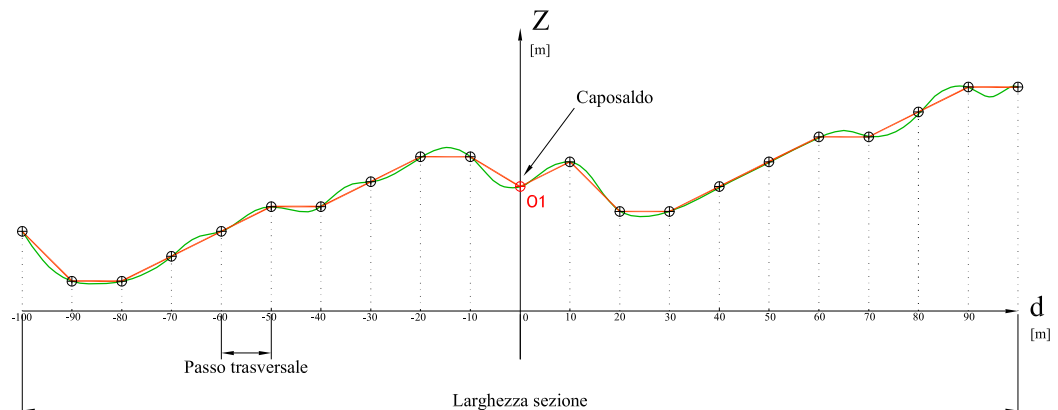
Rappresentazione del terreno sul piano di sezionamento
